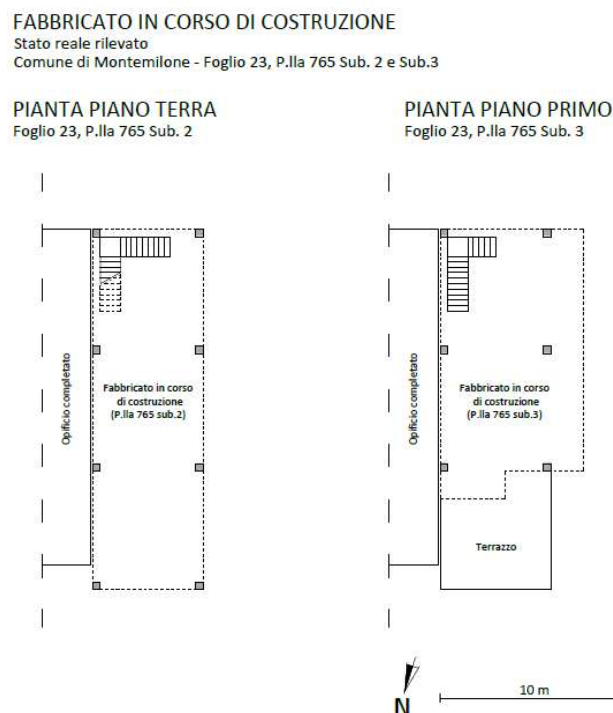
Planimetria stato reale rilevato – Fabbricato in corso di costruzione: F.23 P.IIa 765 sub.2 (PT) e sub.3 (P1°)
